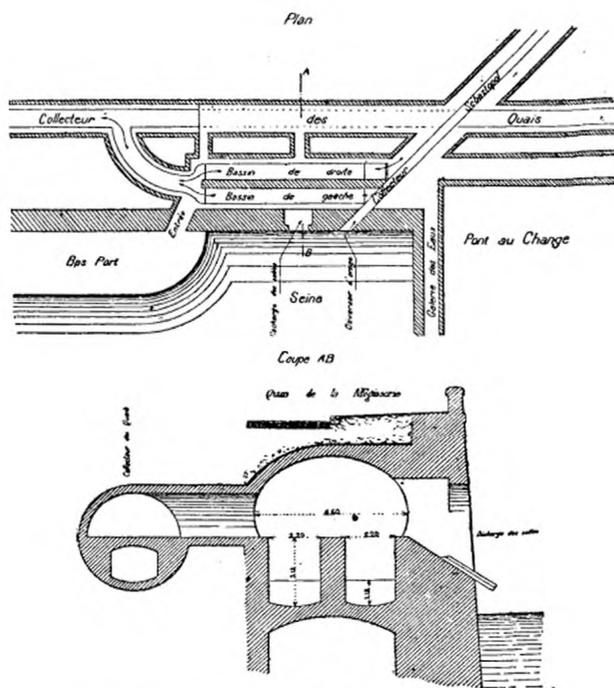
Chambre ou bassin à sable du Châtelet.
